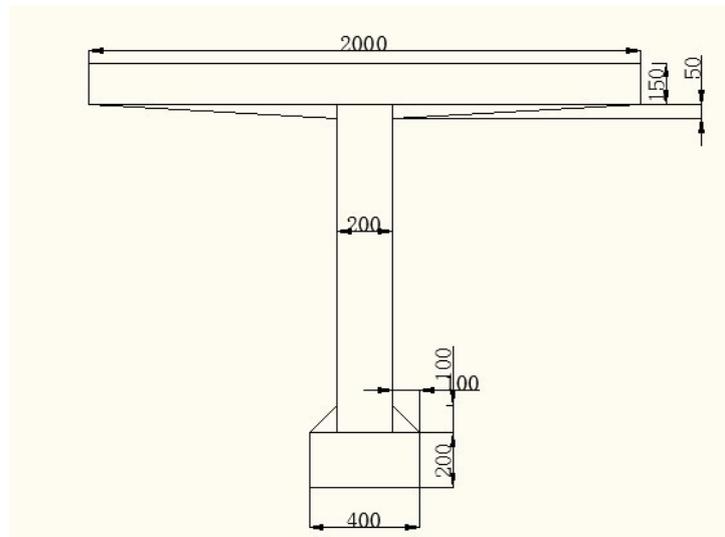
预应力梁的跨中尺寸图 单位 (mm)
